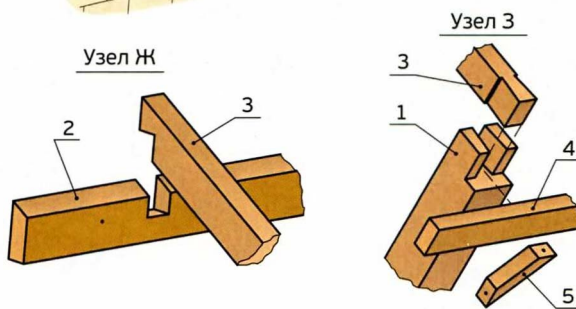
Детали козырька: 1 — стойка; 2, 4 — опорные бруски; 3 — балка; 5 — подкос; 6 — металлический уголок.
